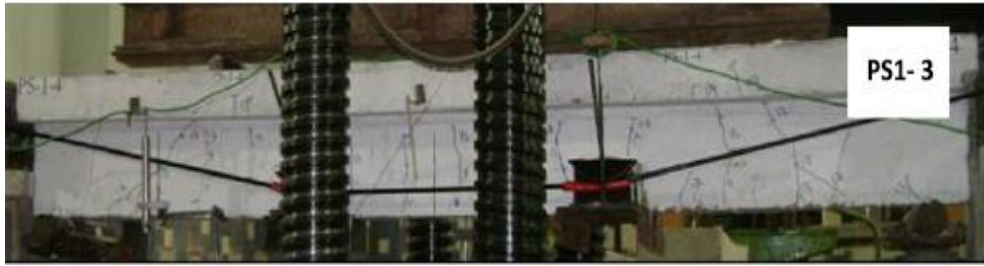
Yang ve ark.'na ait kiriş detayı [5]
